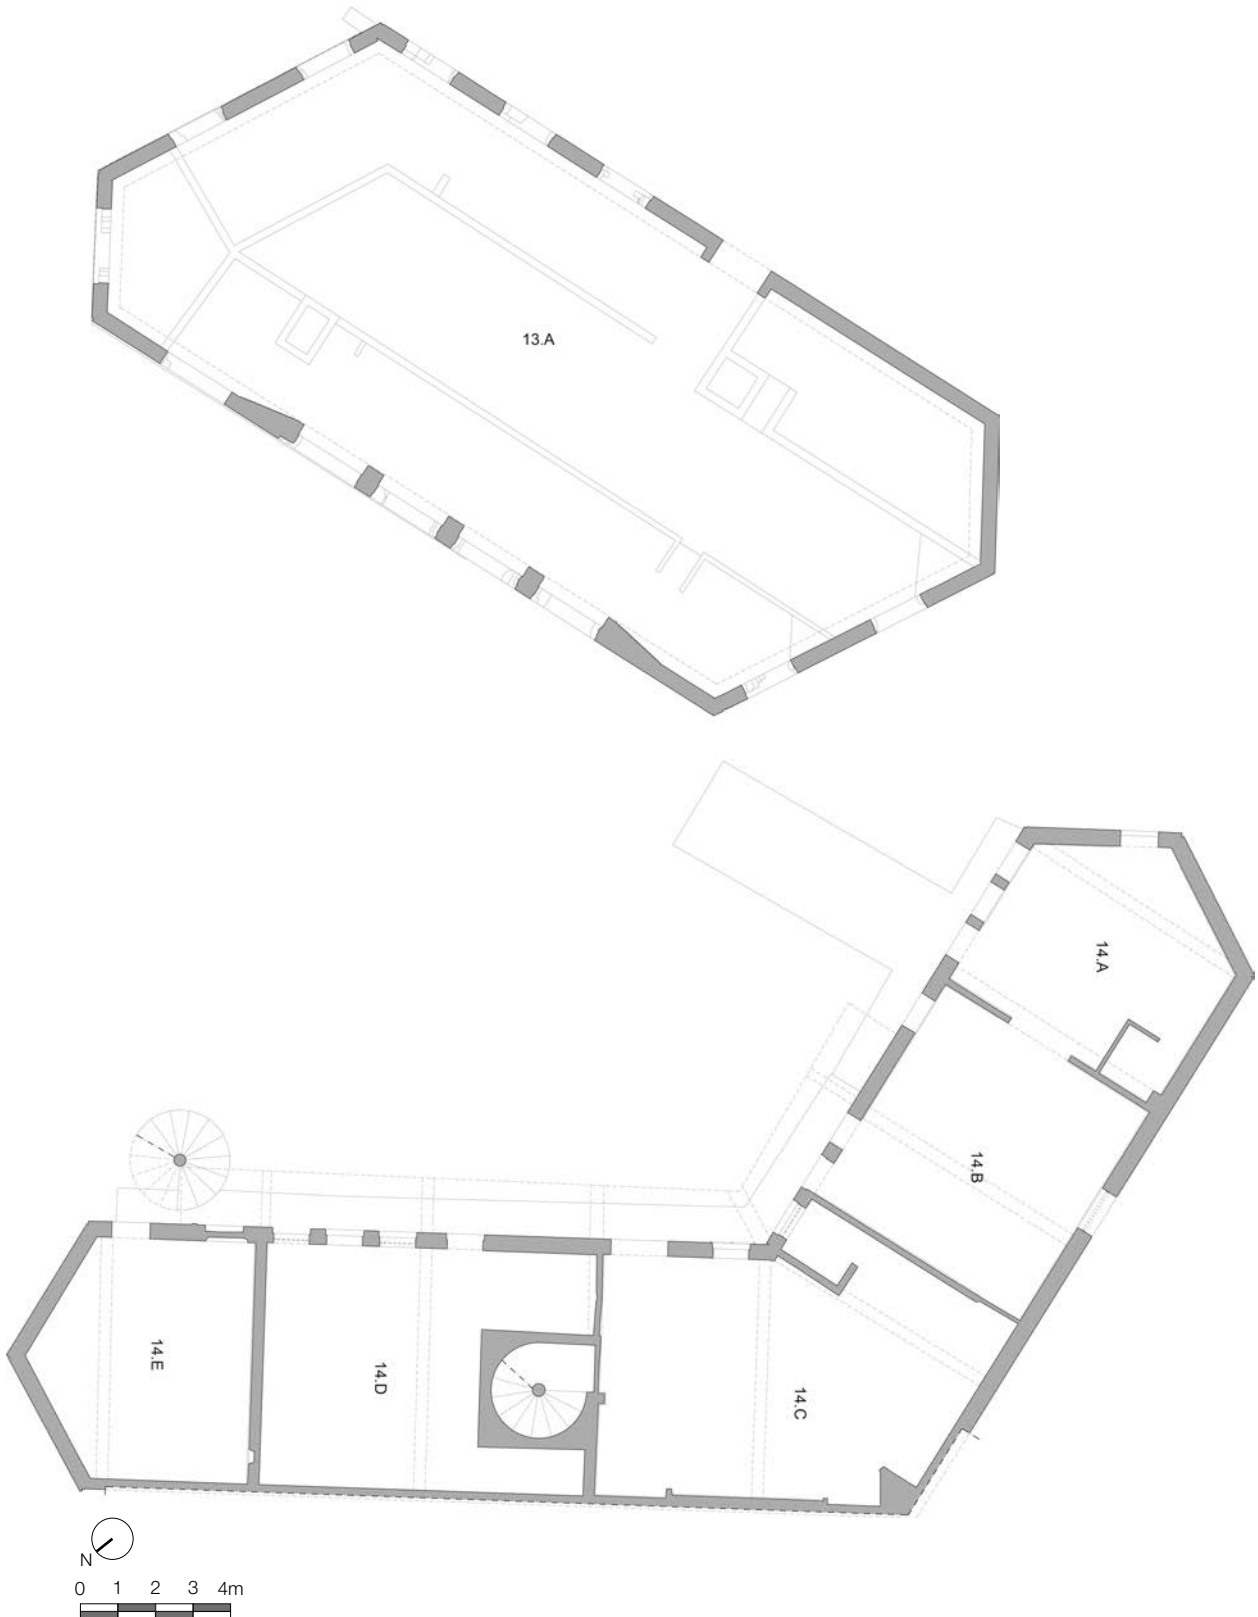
| Planta de los bloques 13 y 14 (escala original de representación 1:50). |
